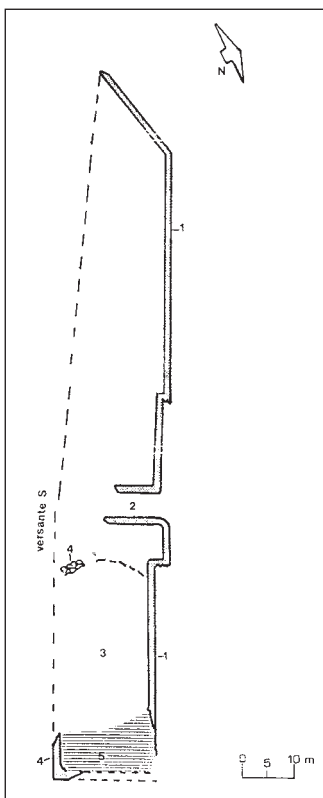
Planimetria della casa murata (o del castello) del Colle di Brenta, tratta da BRIDA 1971: 1. muraglione - 2. ingresso (?) - 3. collinetta artificiale (?) - 4. lacerti murari a Sud-Ovest ed a Sud-Est - 5. area della torre (?; BRIDA 1971, p. 265).
